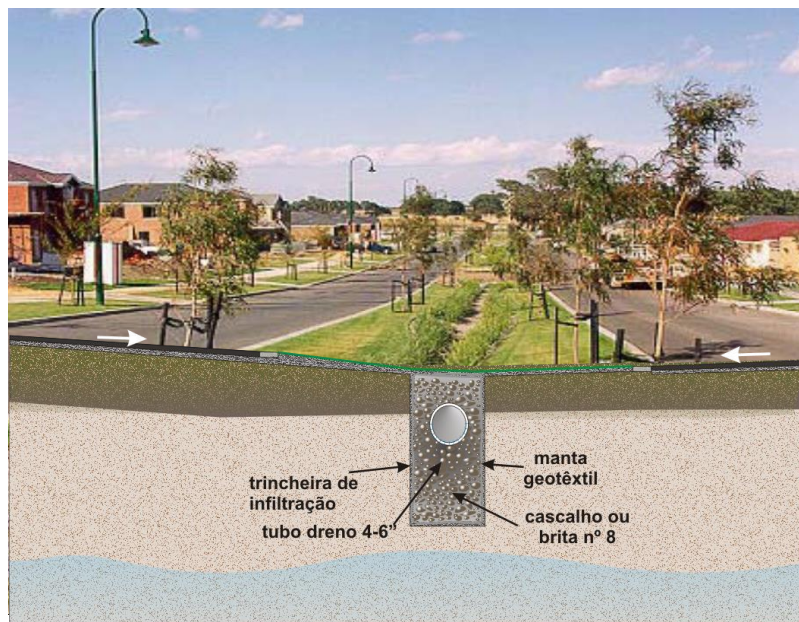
5: TRINCHEIRA DE INFILTRAÇÃO EM CANTEIRO CENTRAL – WSUD
